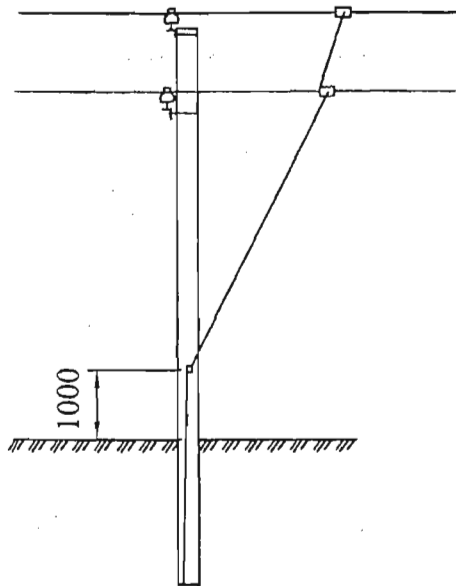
Схема присоединения переносных заземлений к железобетонной опоре ВЛ 0,4-10 кВ.
